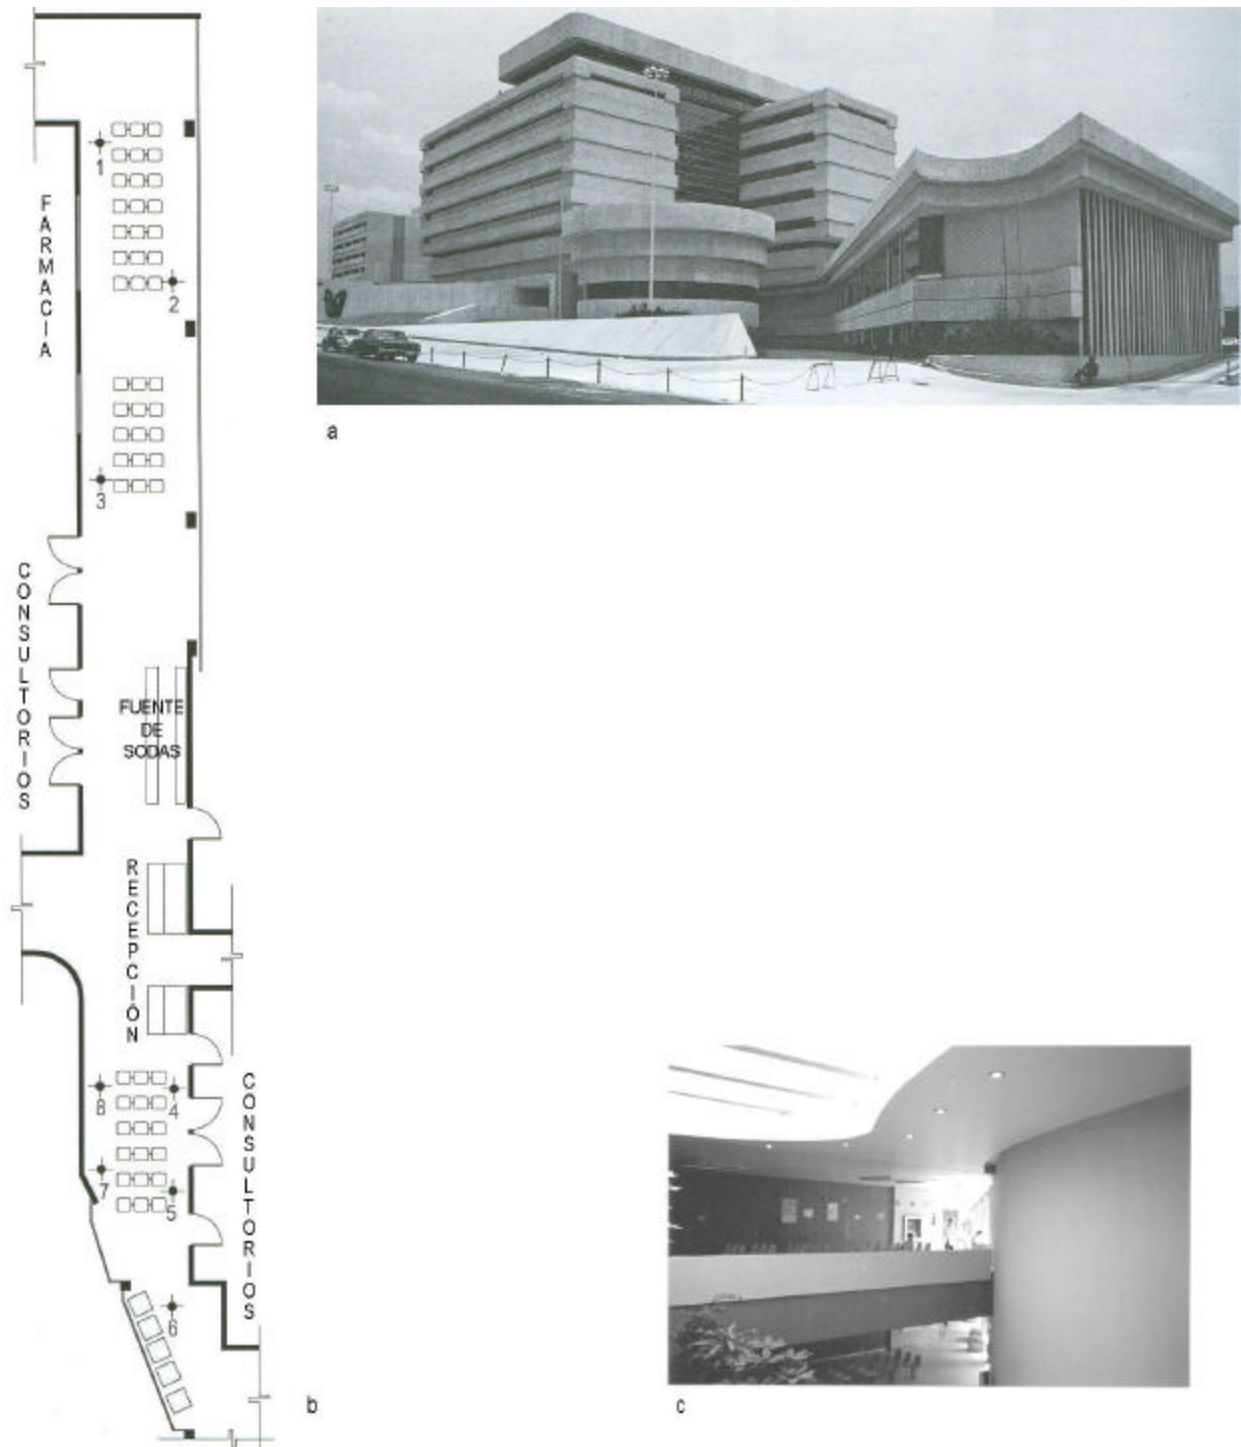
Hospital de Gineco obstetricia No. 4, a: Vista exterior desde el eje 10,¹² b: Planta arquitectónica de salas de espera de consulta externa en planta alta, c: Sala de espera donde se localizan los puntos de medición 4-8.
